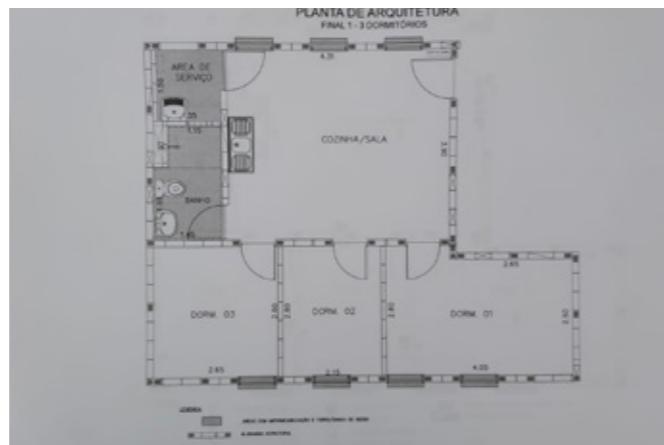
Planta da unidade habitacional com três dormitórios. Acervo do autor
